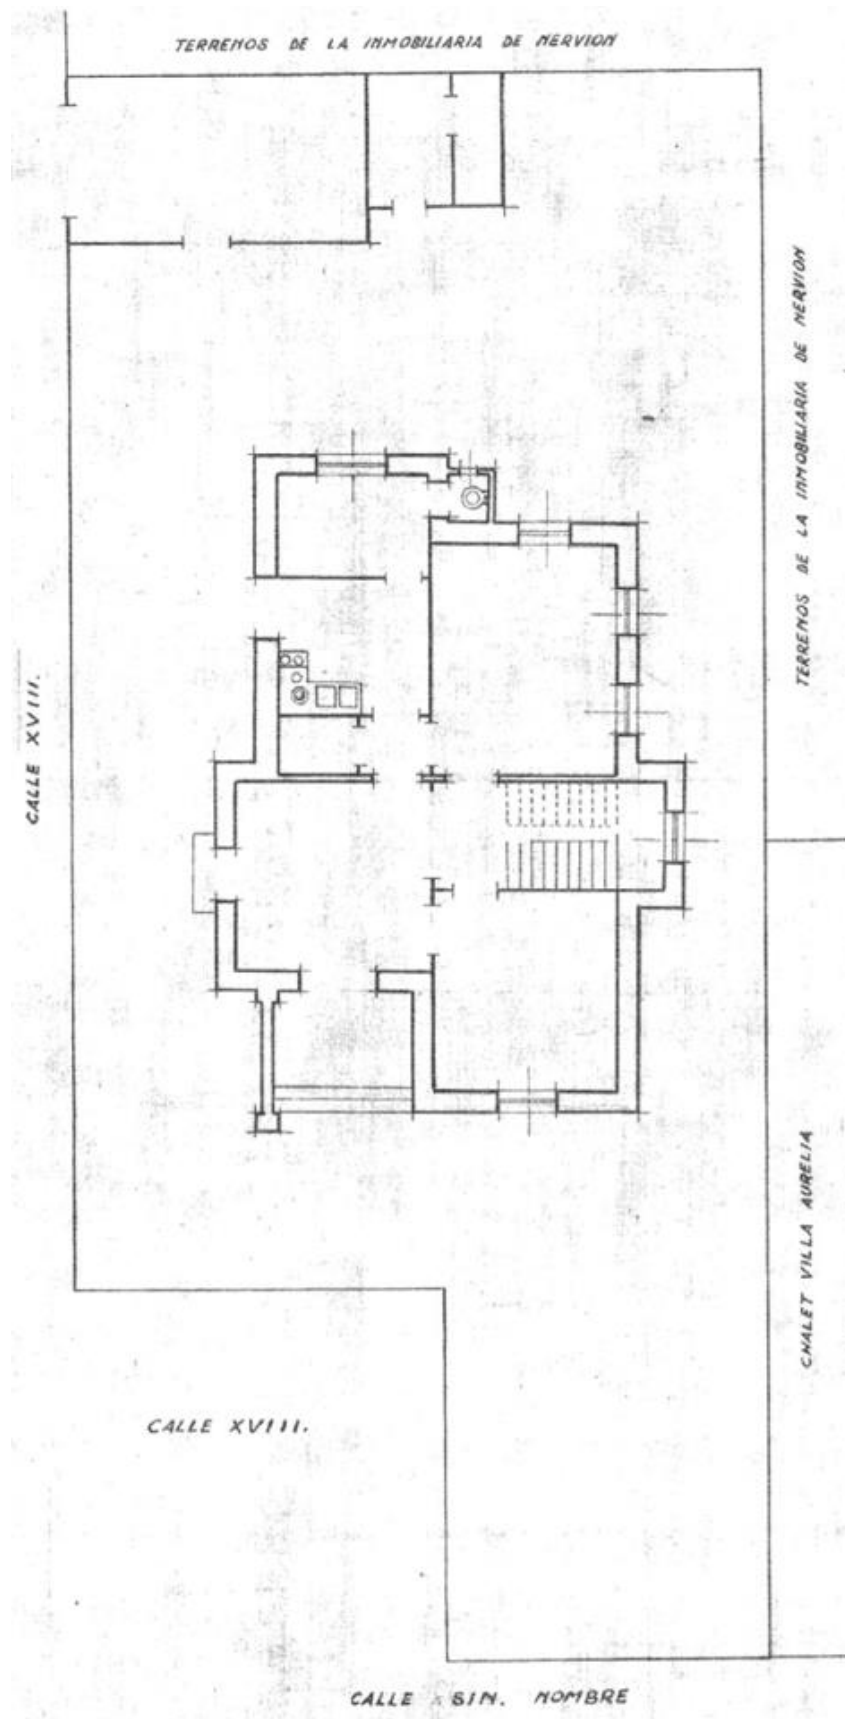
Plano original de planta primera (Fuente: Gerencia de Urbanismo)
